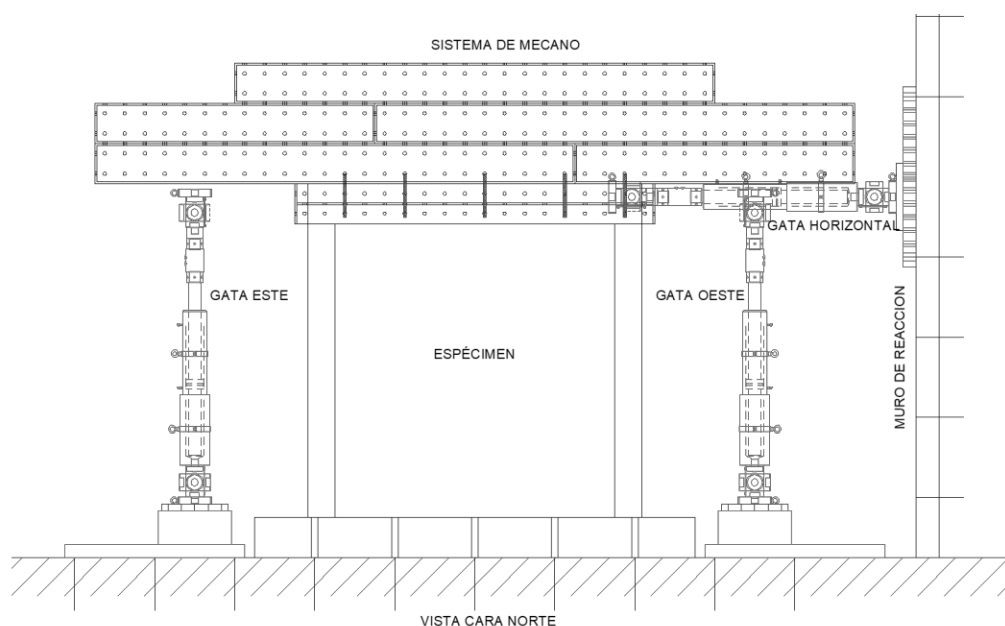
Esquema de la Configuración del Ensayo Cíclico (vista elevación).
